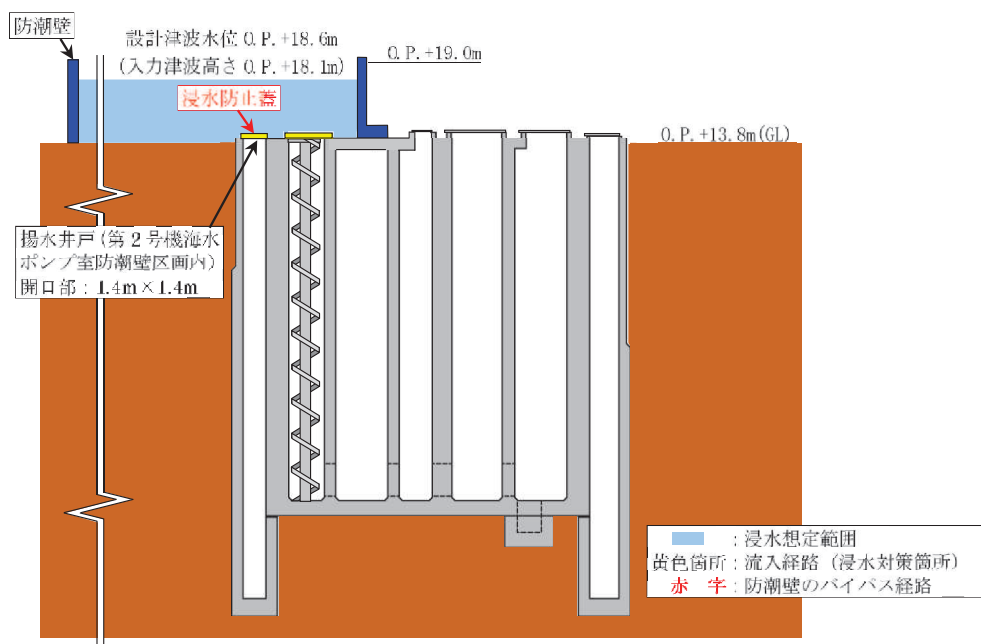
(2) 第 2 号機 海水ポンプ室 浸水対策配置図 (B-B 断面図)
